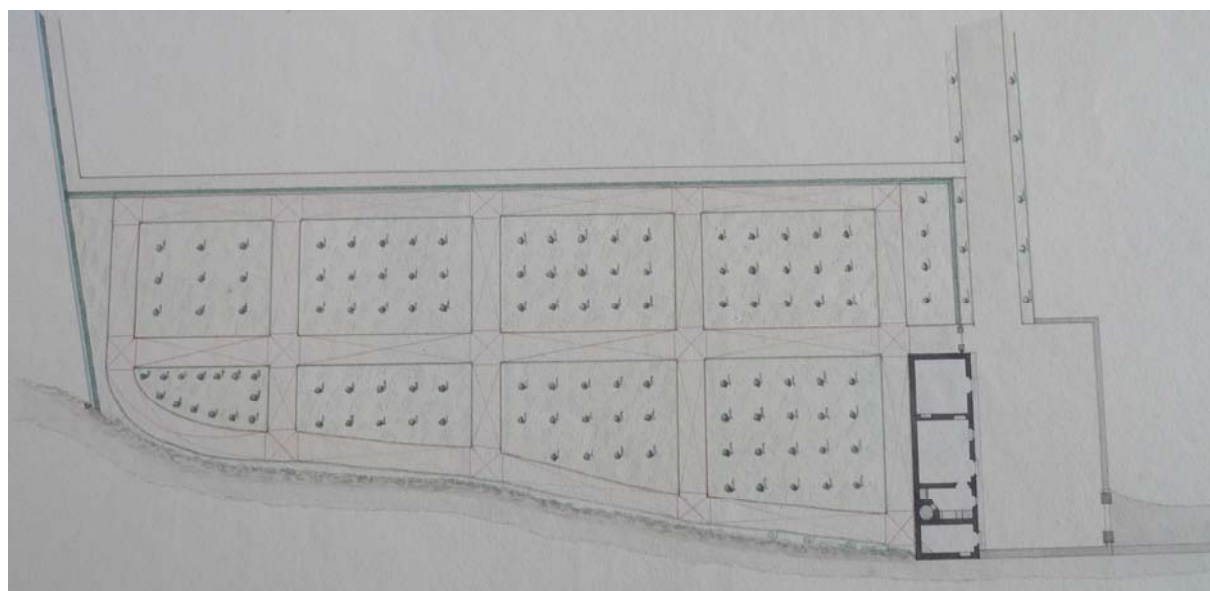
Planimetria dell'edificio e della vigna pergolata del Fellaco, 1800 - 1820 circa (ASRCE, planimetrie 39/E).
